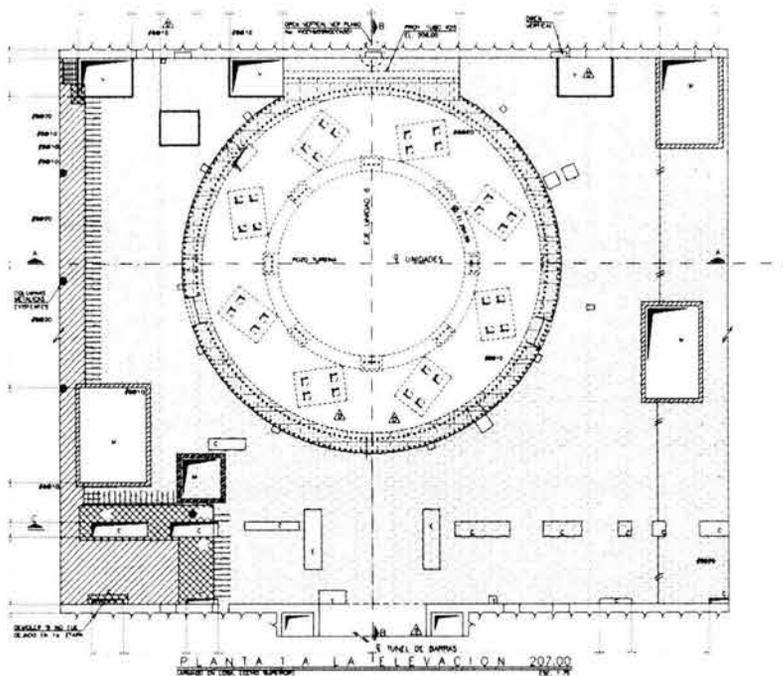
Colado de la losa a la Elev. 207.00 y el muro de empaque de la 206.00 a la 207.00.
